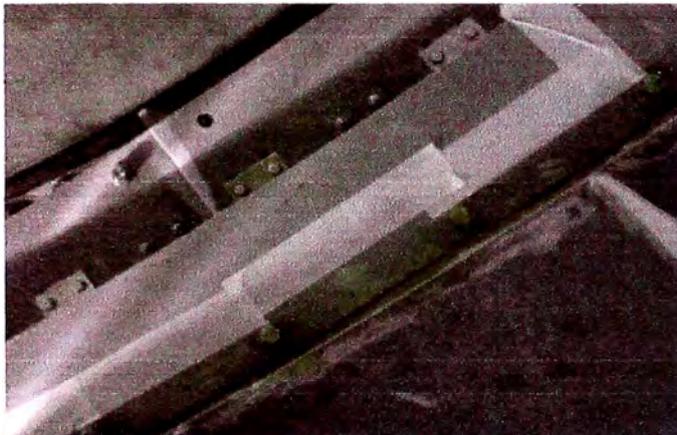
Instalación de protector de lluvia de perfil “T”, (Proyecto Antapaccay).
